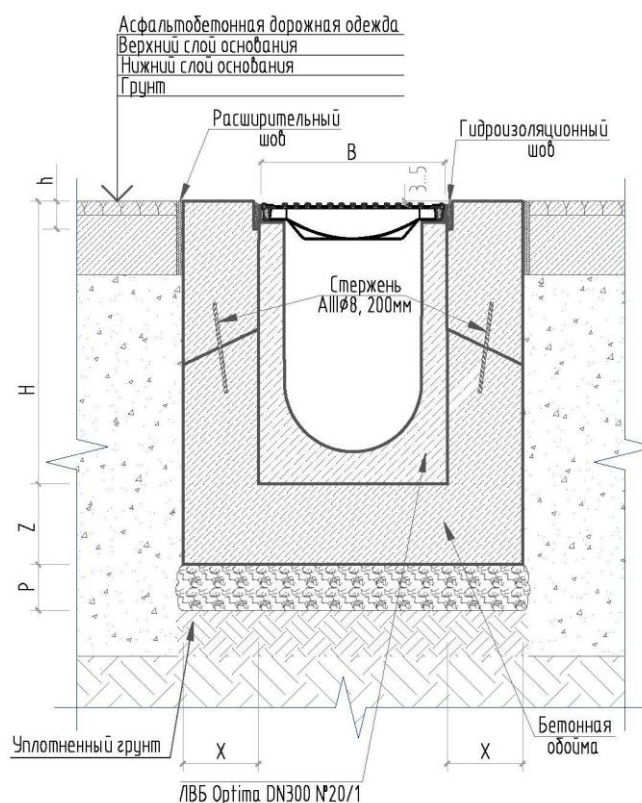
б – Устройство бетонной обоймы лотка с асфальтобетонным покрытием для классов нагрузки от D400 до E600.
